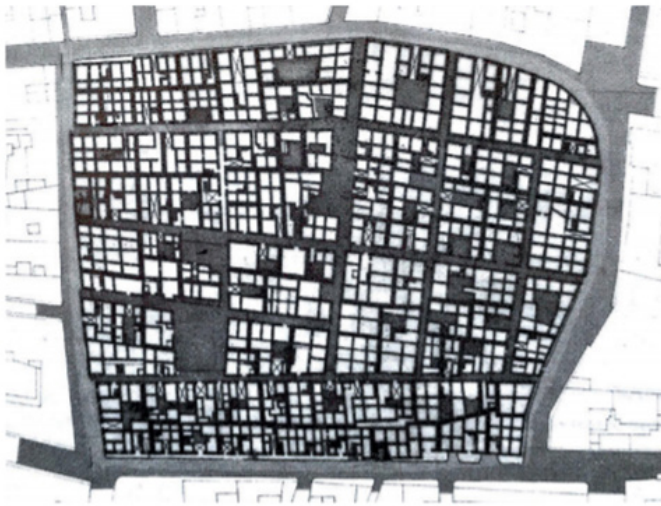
Planimetría del Quadrilatero delle Carceri al estado original
